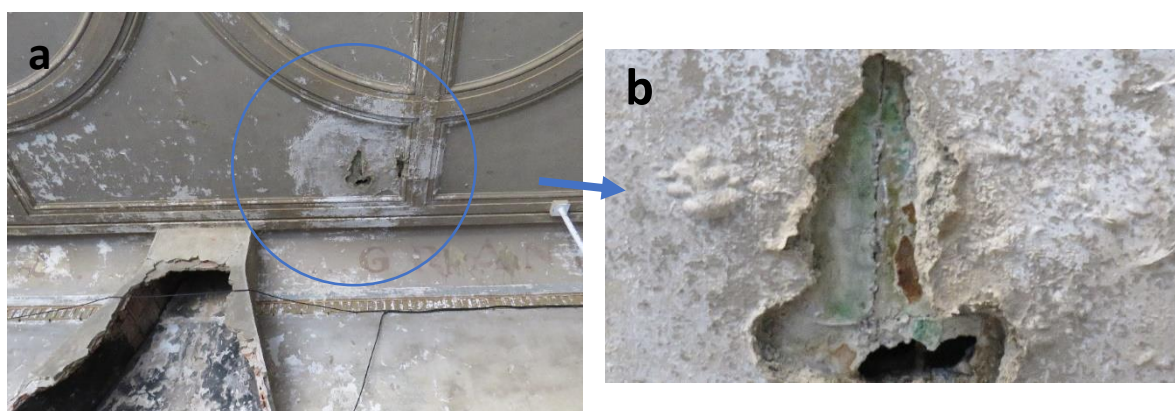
a) Entrada de agua por el techo, y b) Detalle del deterioro ocasionado en el hormigón y las placa de yeso.
